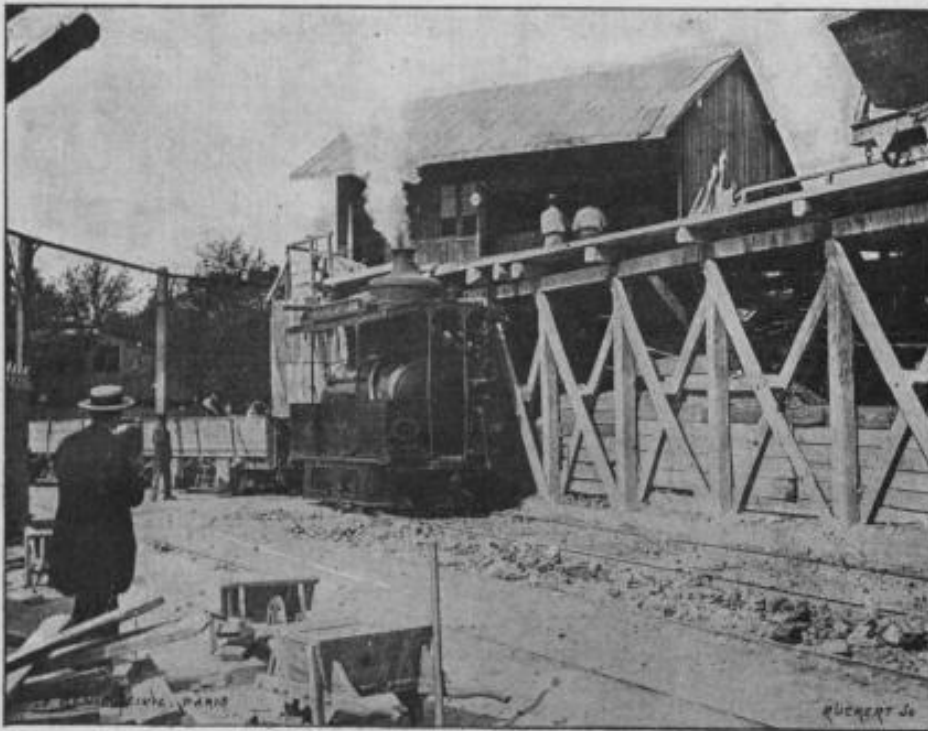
Puits d'extraction du 9^e lot, sur la place de l'Étoile ;
